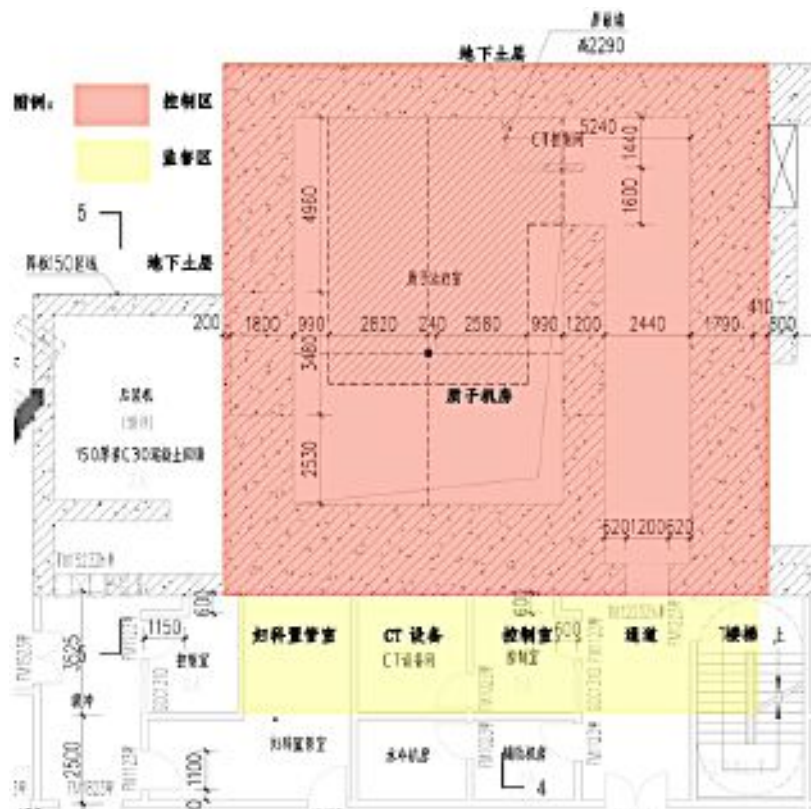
质子治疗机房辐射工作场所分区平面图（负一层：治疗层）
